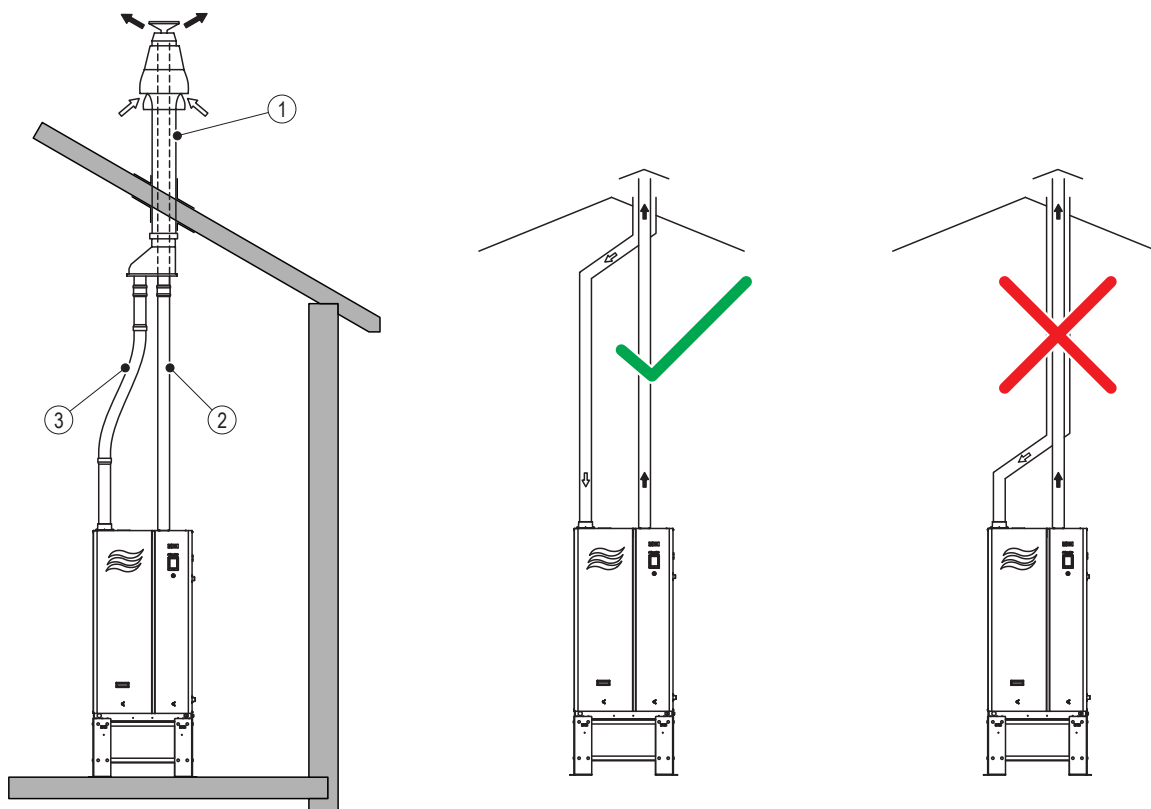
Rookgassysteem voor gesloten verbrandingsinstallaties type 33
